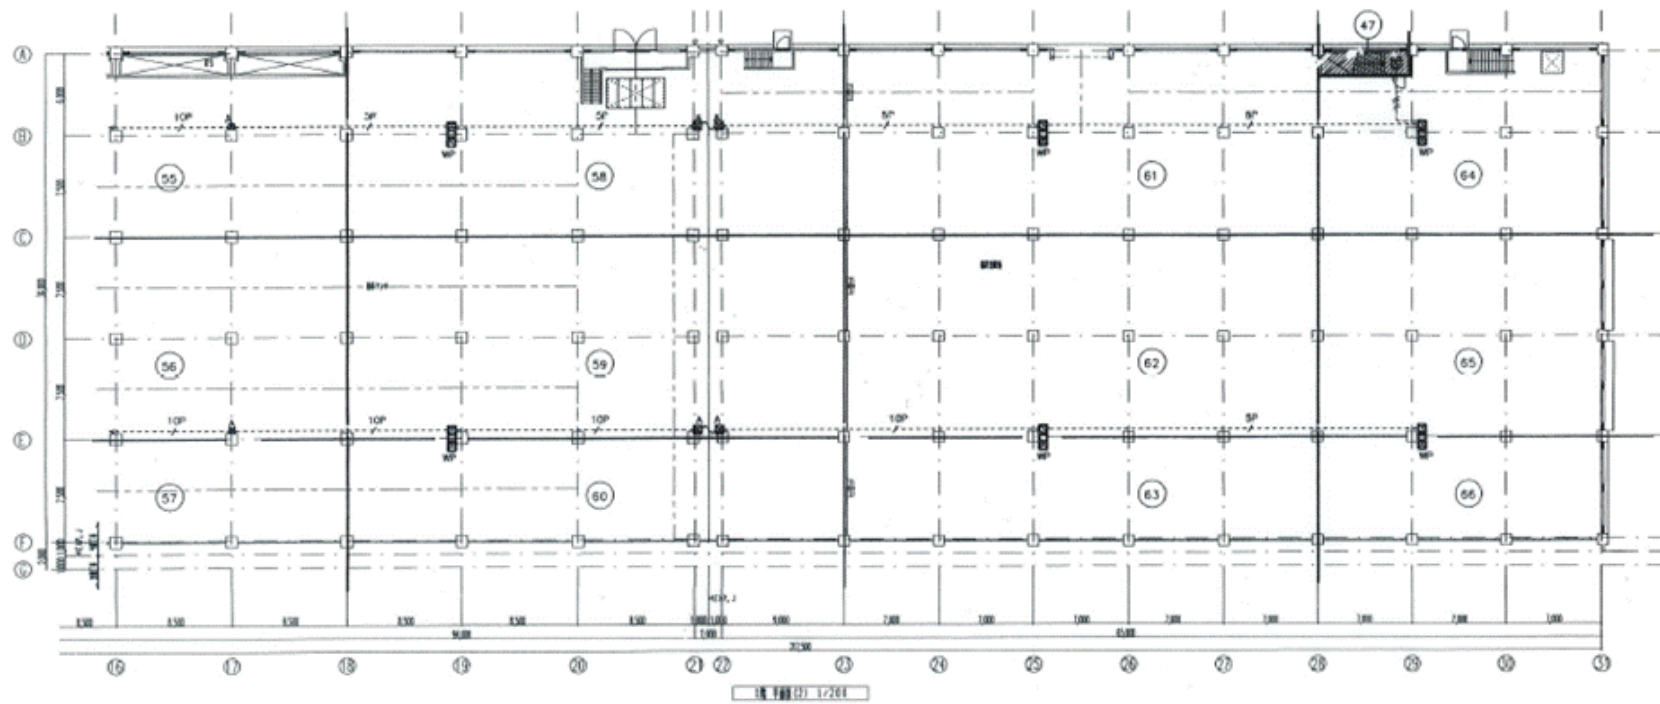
系水処理棟（反応タンク） 地下1階平面図（既設）
